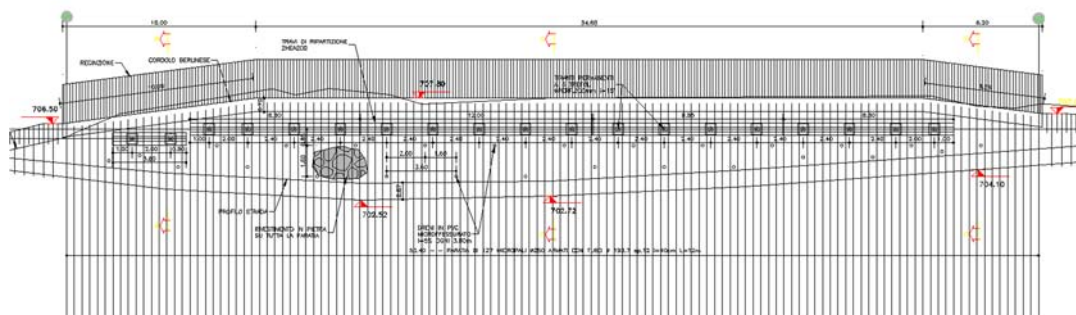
Prospetto berlinese di collegamento alla viabilità esistente
